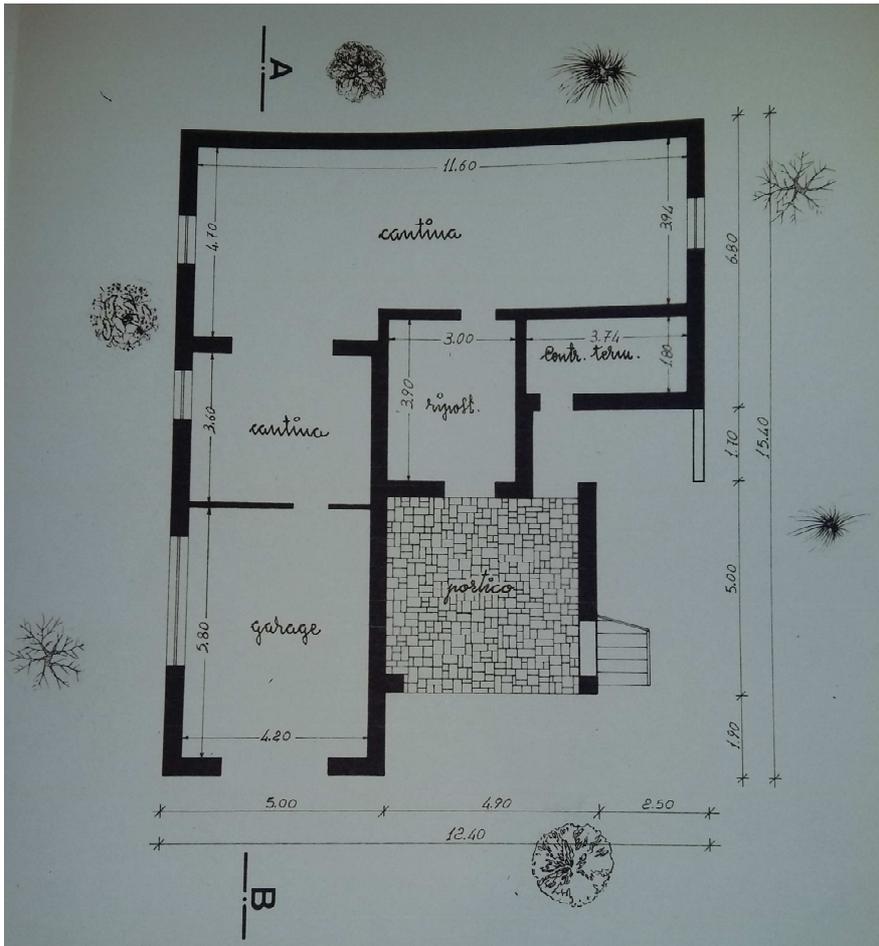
Pianta piano interrato dell'edificio campione.
